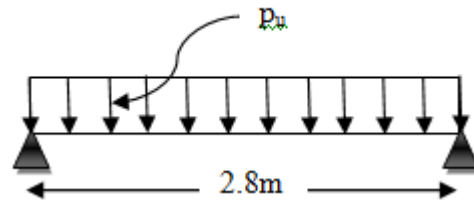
Schéma statique de la poutre palier du 5^{ème} Type d'escalier.
